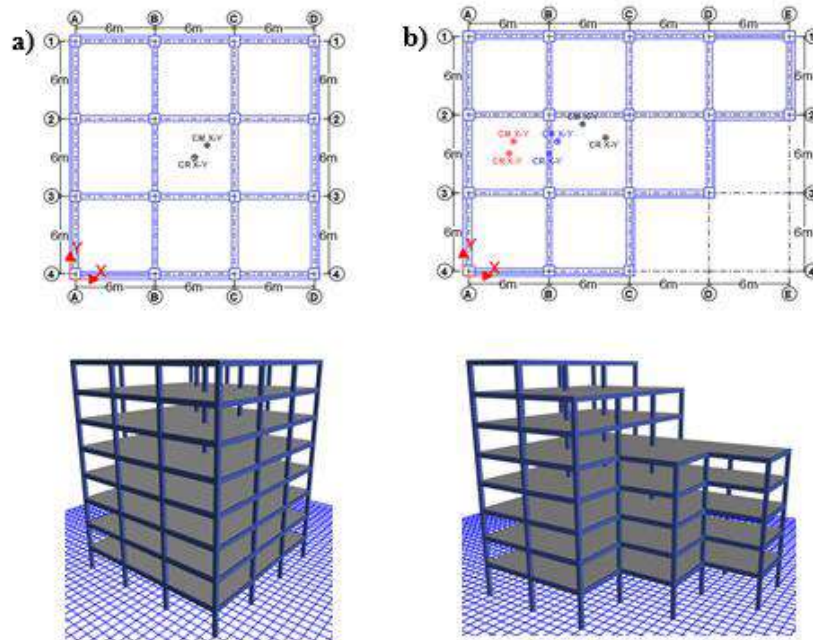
Ilustración de modulación estructural. Fuente: <https://tectonica.archi/materials/sistema-constructivo-ligero-de-perfiles-de-acero-galvanizado/>
